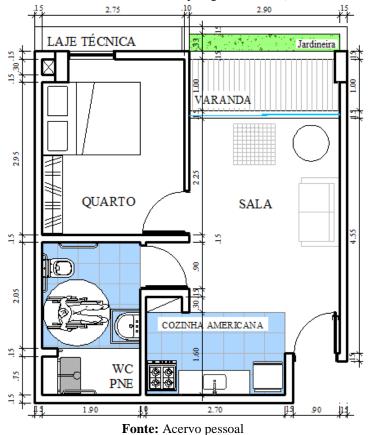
Planta Baixa da UHA de Tipologia acessível (1º ao 11º Pavimento)
